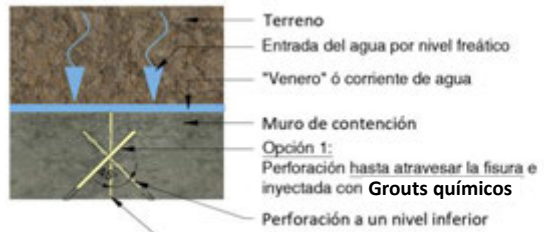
Vista en corte Superior – inyección con Grouts químicos restringiendo el paso del agua por la fisura
